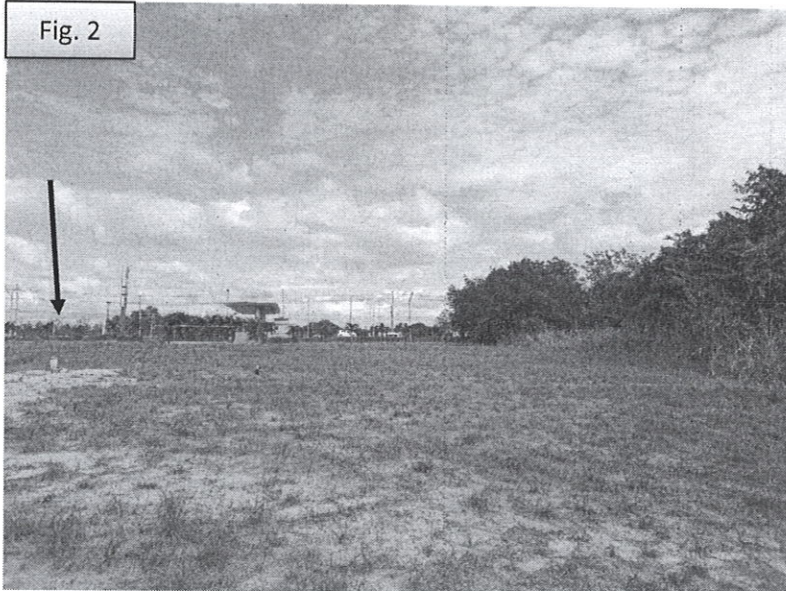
Se puede observar el tipo de vegetación y topografía existente en el área del proyecto. Igualmente se puede observar el área del pozo existente.
